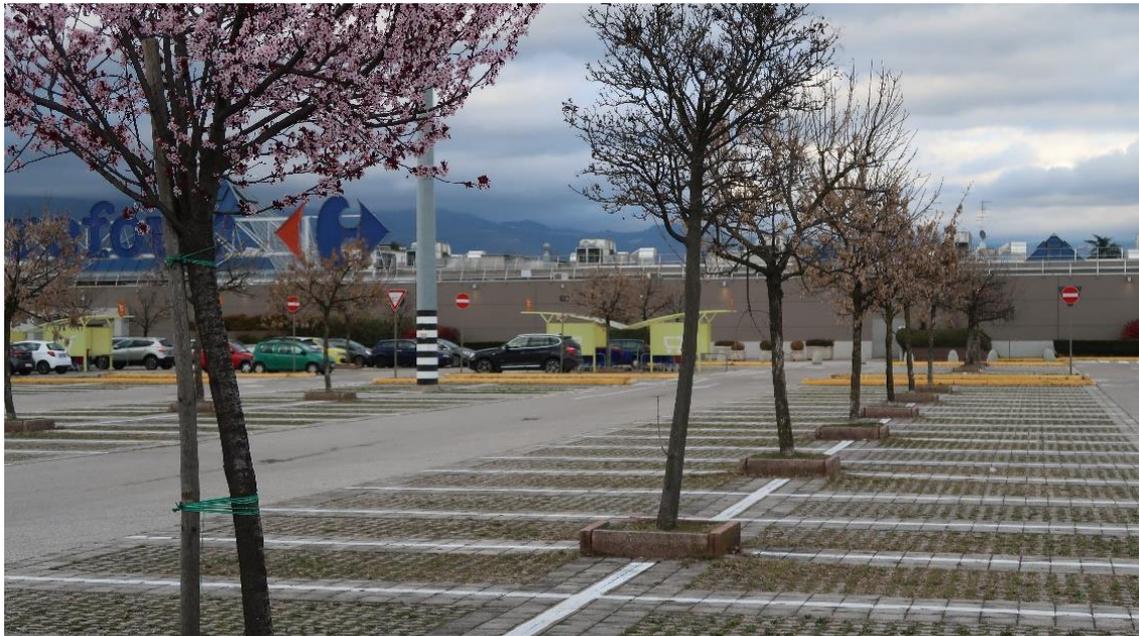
vista delle piante del parcheggio e delle formelle che le ospitano da sud-ovest
